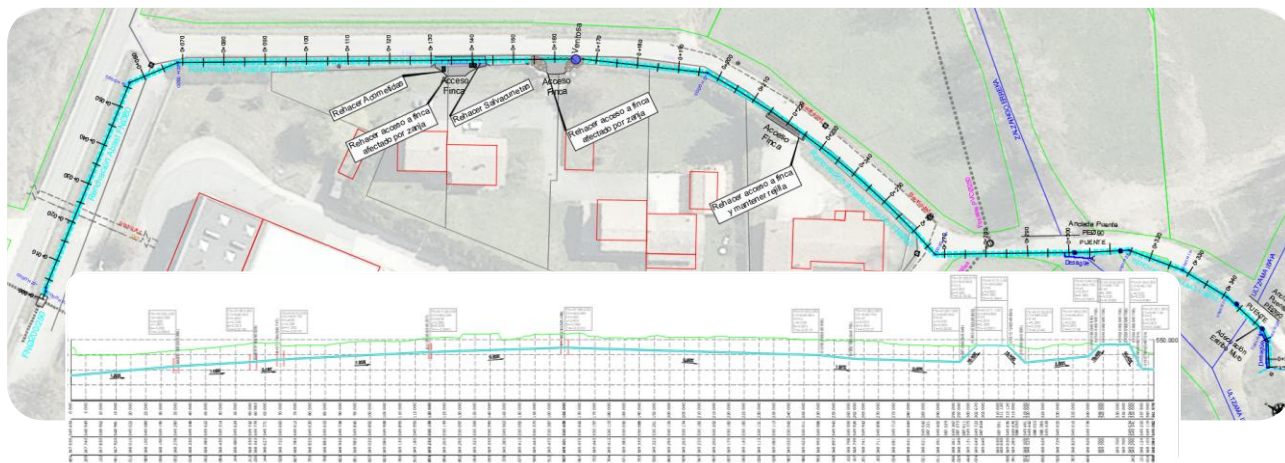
Planta y longitudinal diseñados para la renovación del Ramal de Lozen
